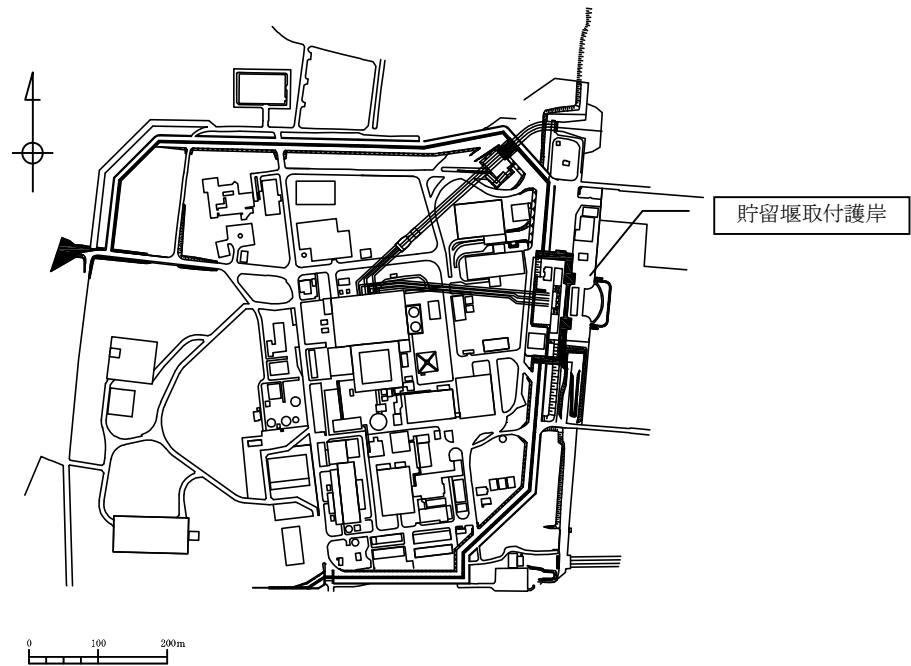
(1) 貯留堰取付護岸の平面配置図（全体図）
